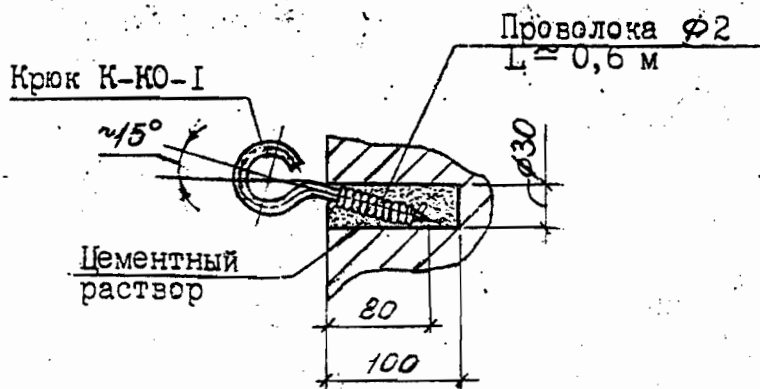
Крепление крюка К-КО-1 в кирпичной (железобетонной) стене здания
